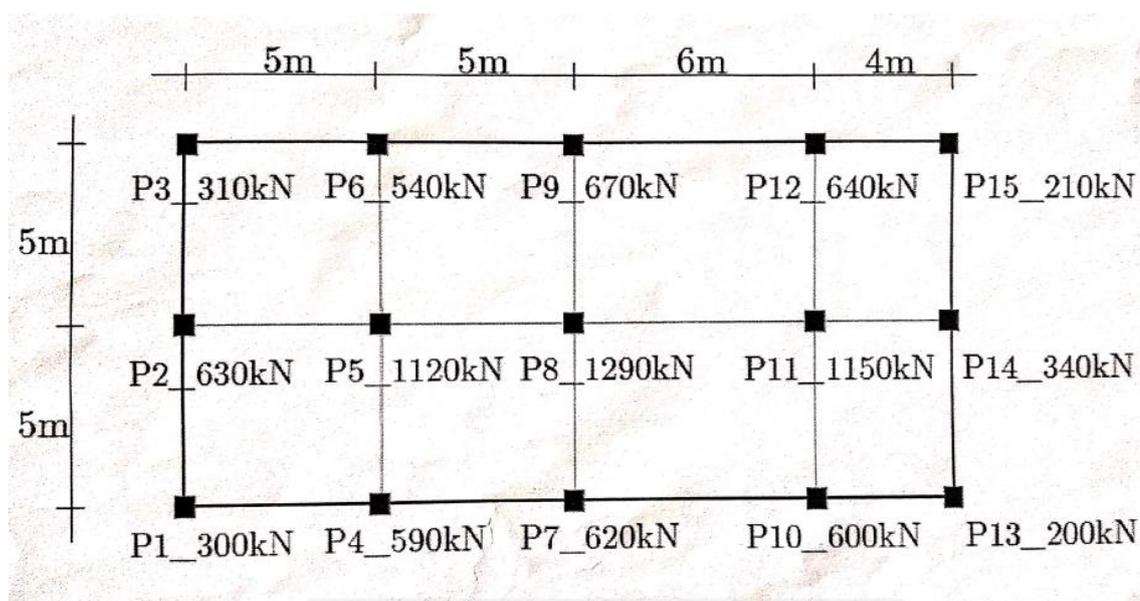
3. Plano en planta de la vivienda con las cargas recibidas por cada pilar.
